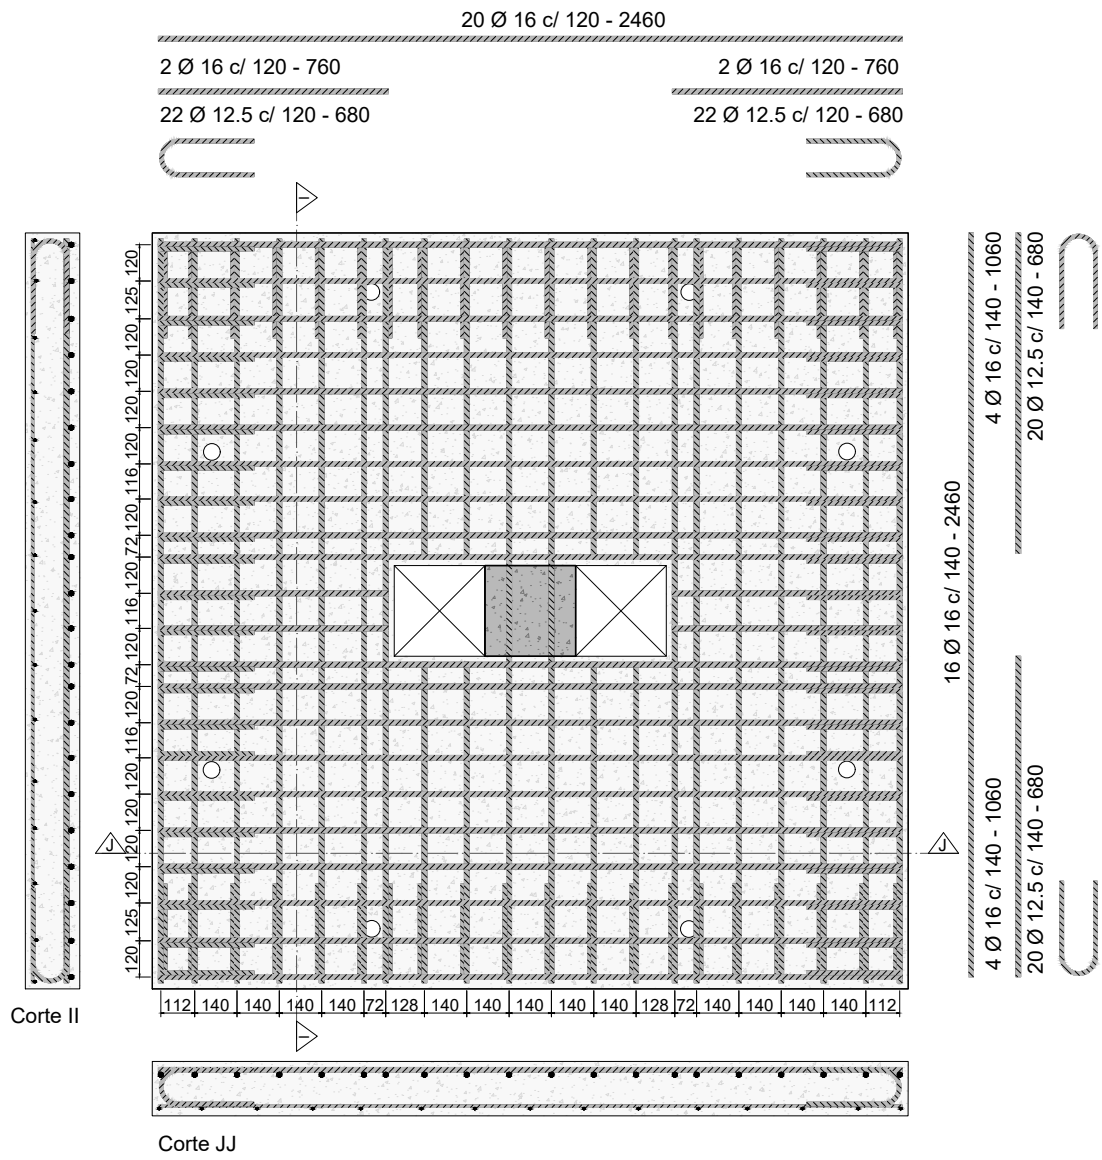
Armaduras de flexão negativa das lajes com aberturas
